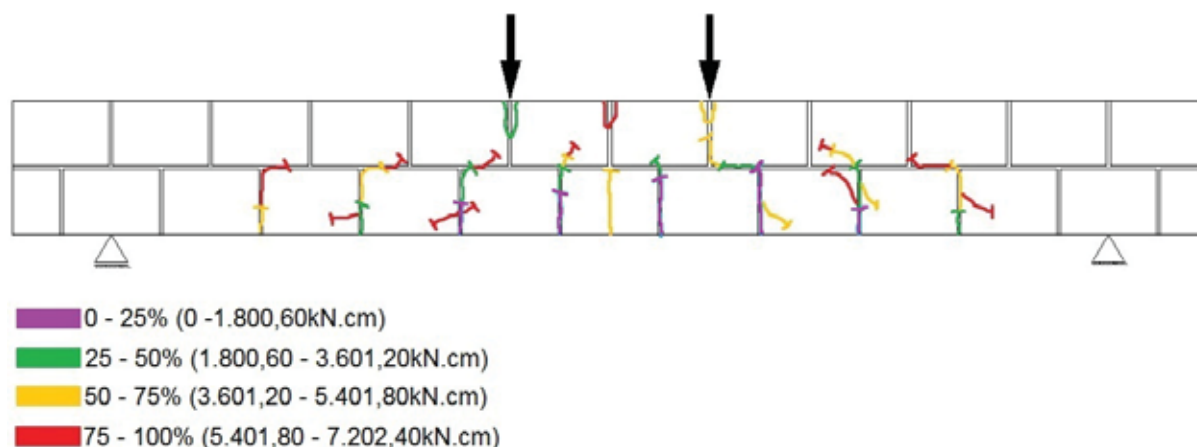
Histórico de fissuração das vigas V2F6, V2F7 e V2F8
